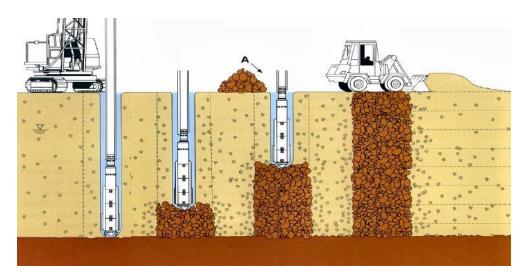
Esquema de construcción por vía húmeda. Fuente: (Raju et al., 2004, citado en Cimentada, 2009).
